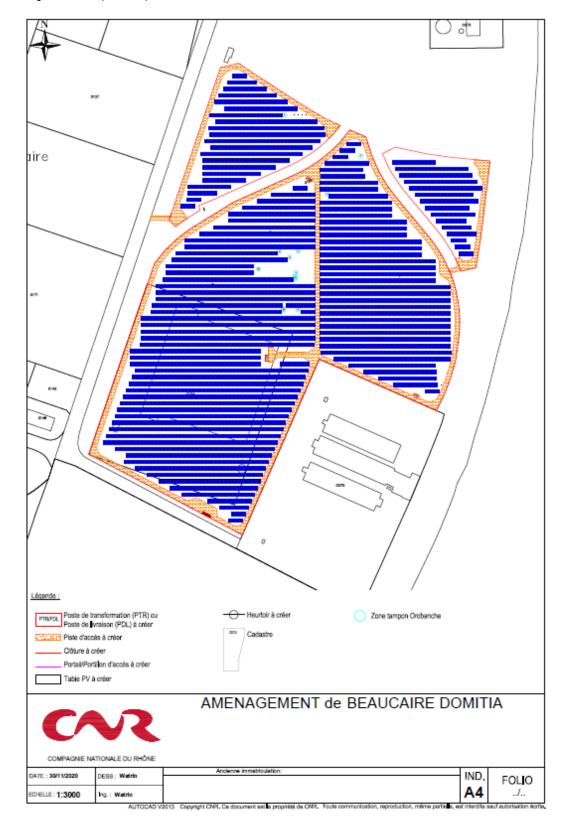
Plan de masse de la variante 4 (novembre 2020)
